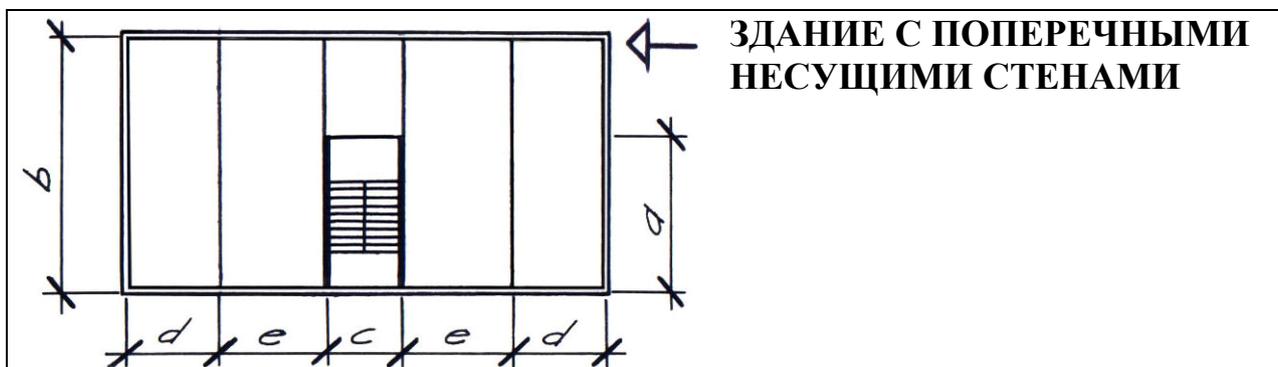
Схема плана здания с поперечными несущими стенами
